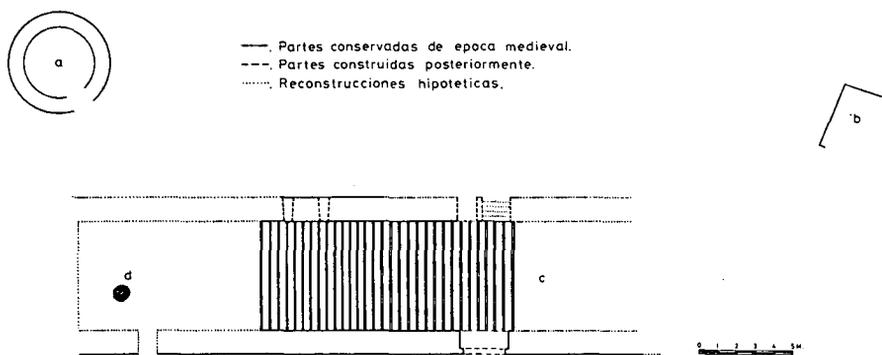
Planta baja. Primera etapa constructiva: a y b) torres; c) cuerpo de edificio; d) posible aljibe. Reconstrucción de los Tovar: la cubierta en alfarje.
